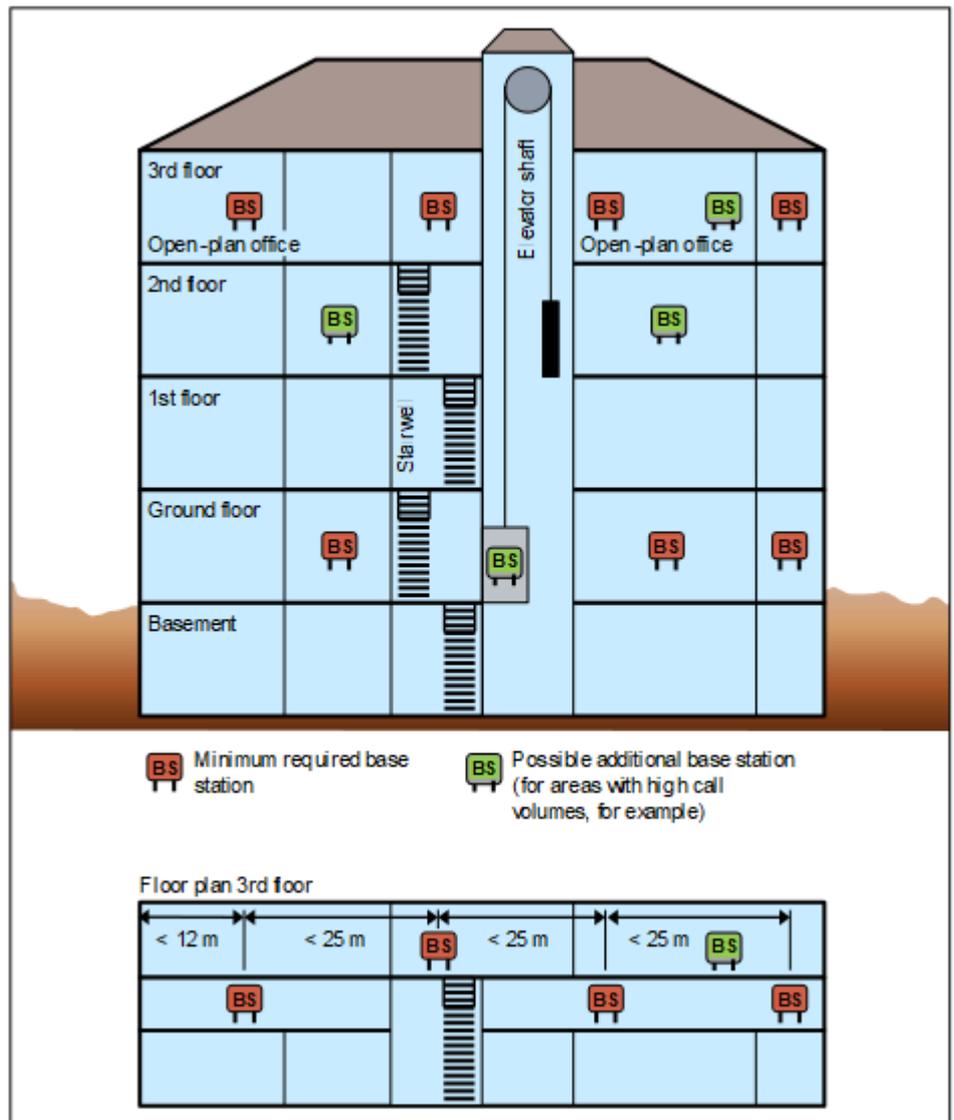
Beispiel für die Positionierung von Basisstationen in Stahlbetongebäuden mit Beton- und Stahltrennwänden
